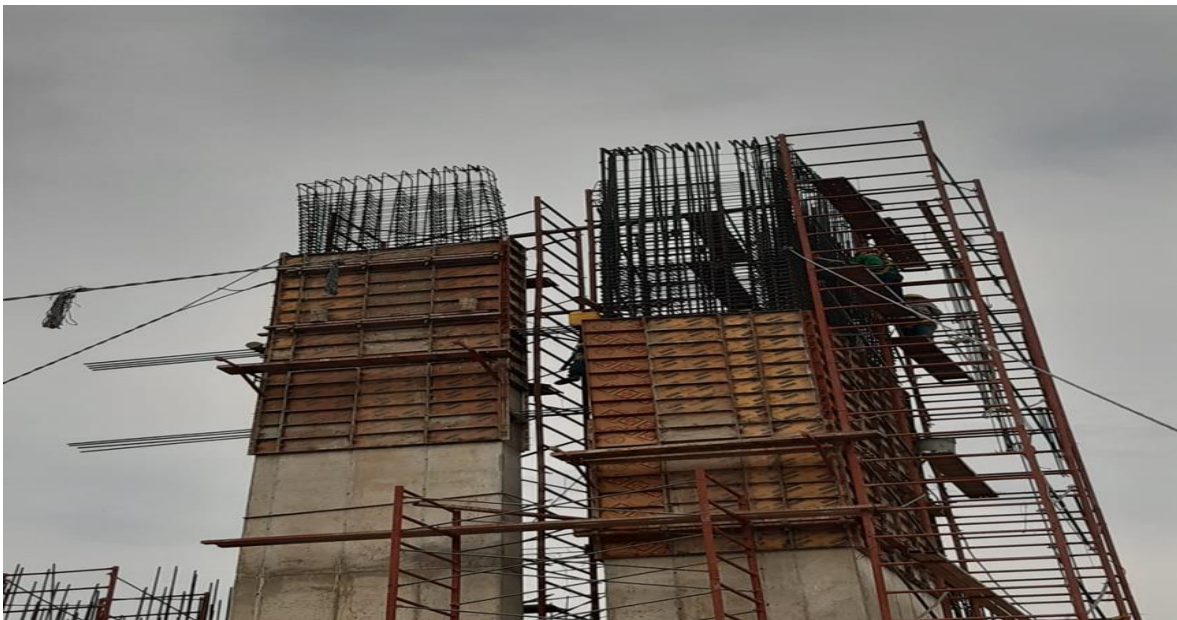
Armado de Acero de Muros Tipo 3 y Tipo 4
